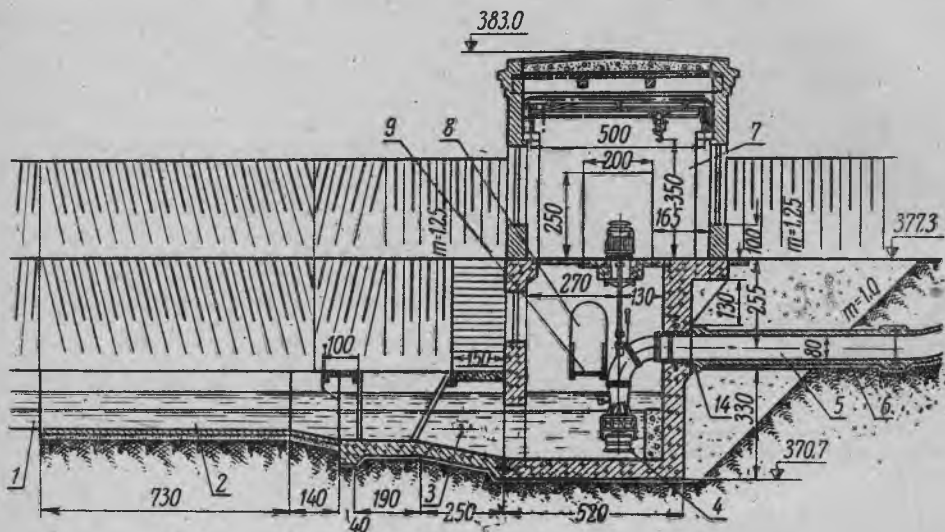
Поперечный разрез здания насосной станции с мокрой камерой и затопленным насосом:
